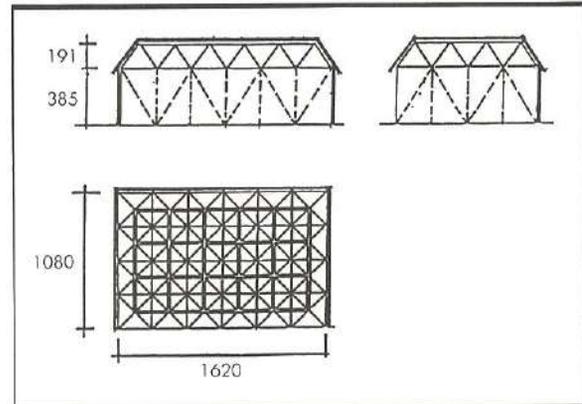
Alzados y planta de un cobertizo agrícola en Leeuwarden.
